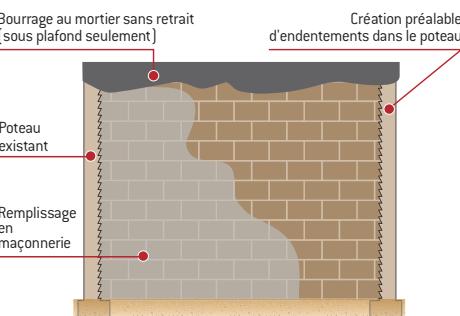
Création d'un mur en maçonnerie entre 2 poteaux existants [élevation]
